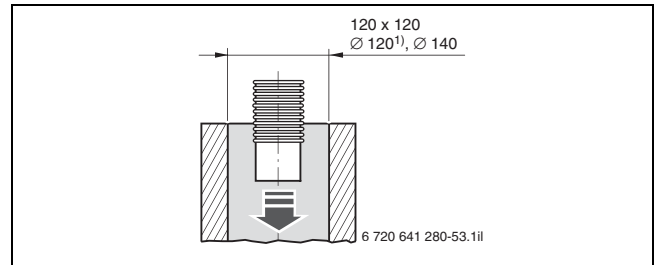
Mindestmaße des Schachtquerschnitts für die Montage der flexiblen Abgasleitung (Maße in mm)
